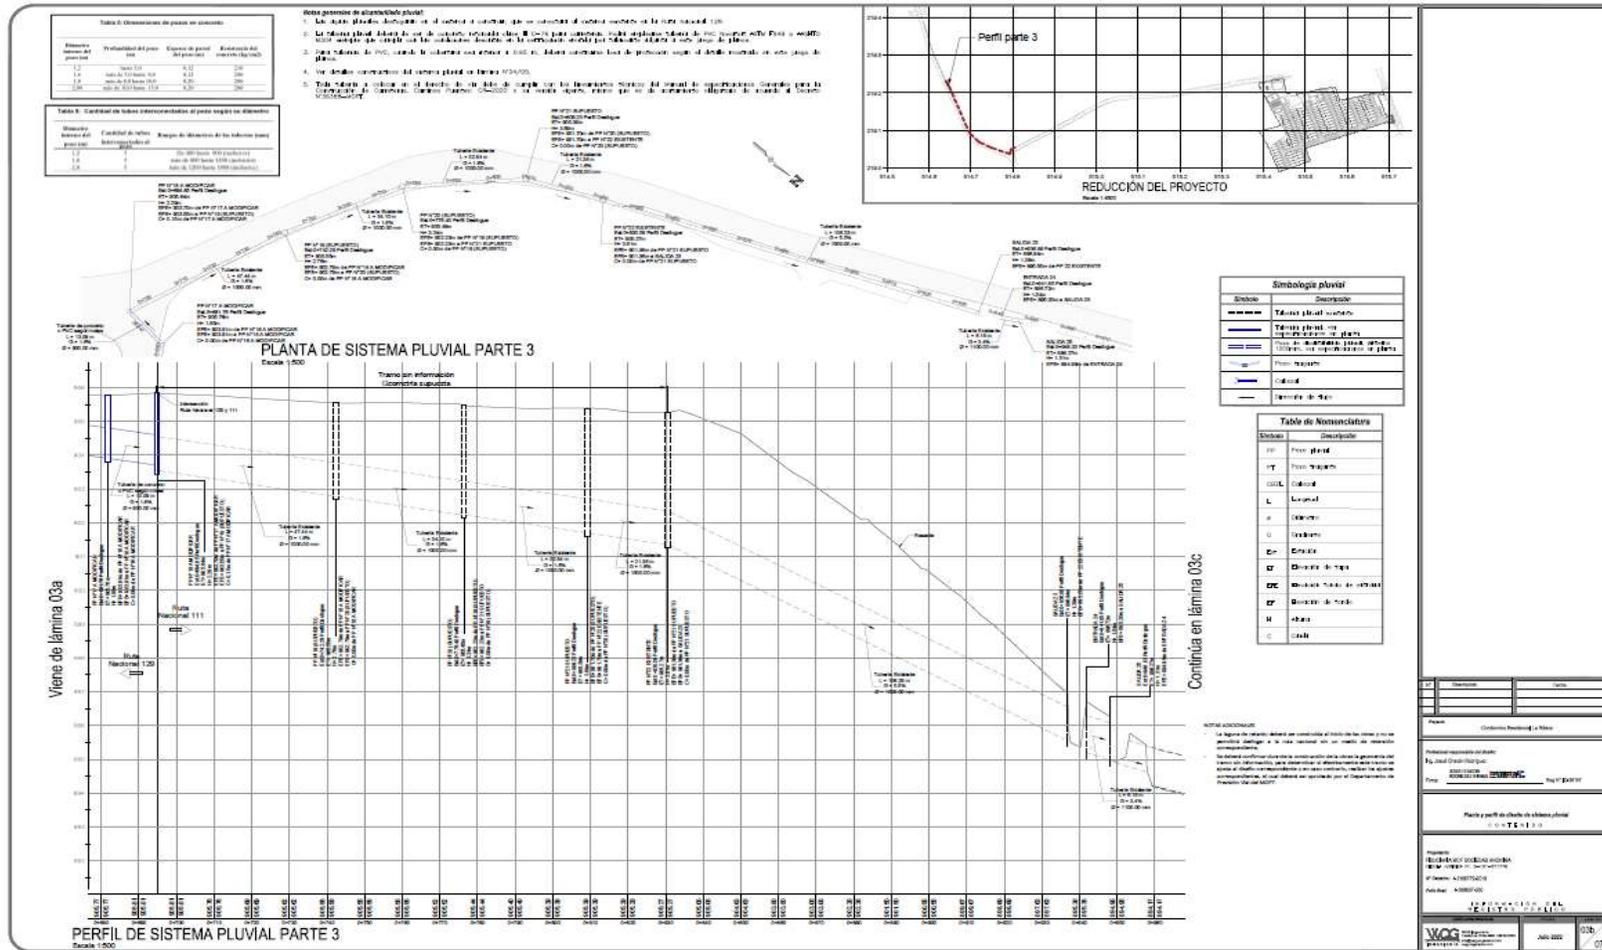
Trayecto de Tubería Pluvial sobre Ruta Nacional # 129, descarga en Río Segundo. (trayecto # III). Lámina Pluvial # 03c
